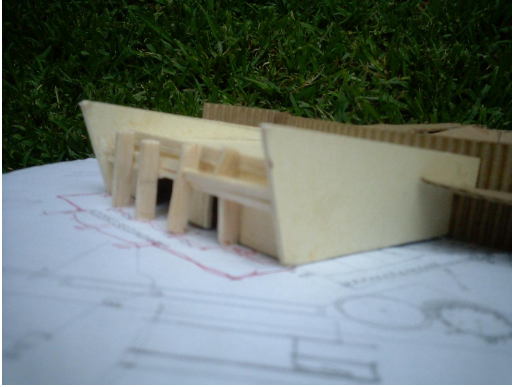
Vista de un acceso secundario      Fig. 67 Entradas del acceso secundario
